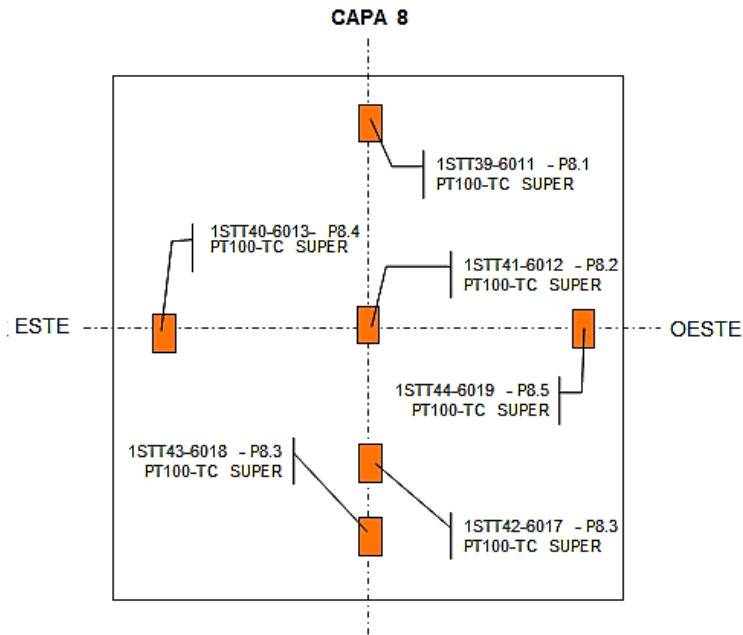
Esquema de montaje de las sondas en la muestra de fachada ventilada ligera
